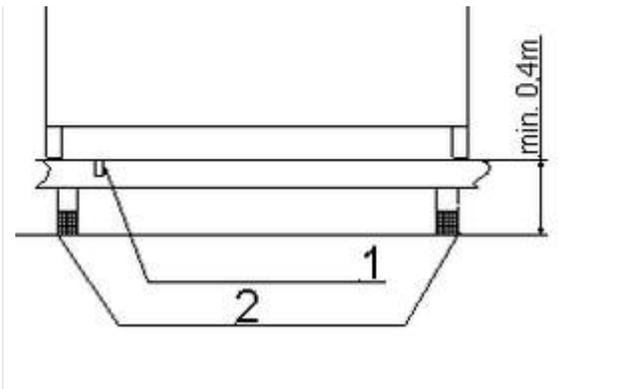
Scarico libero della condensa in elevazione (ad es. tetto di un edificio)
